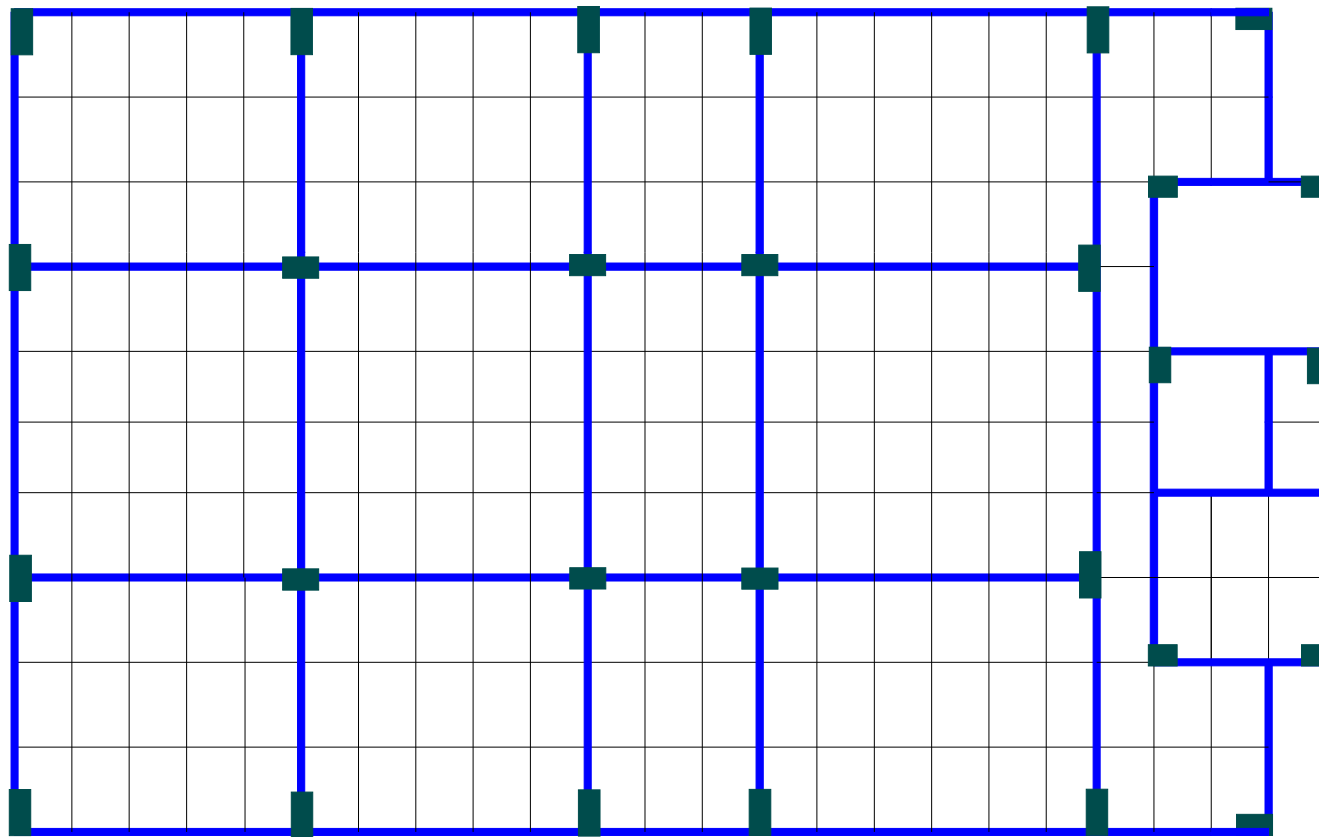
Planta baixa do pavimento tipo do exemplo 01
